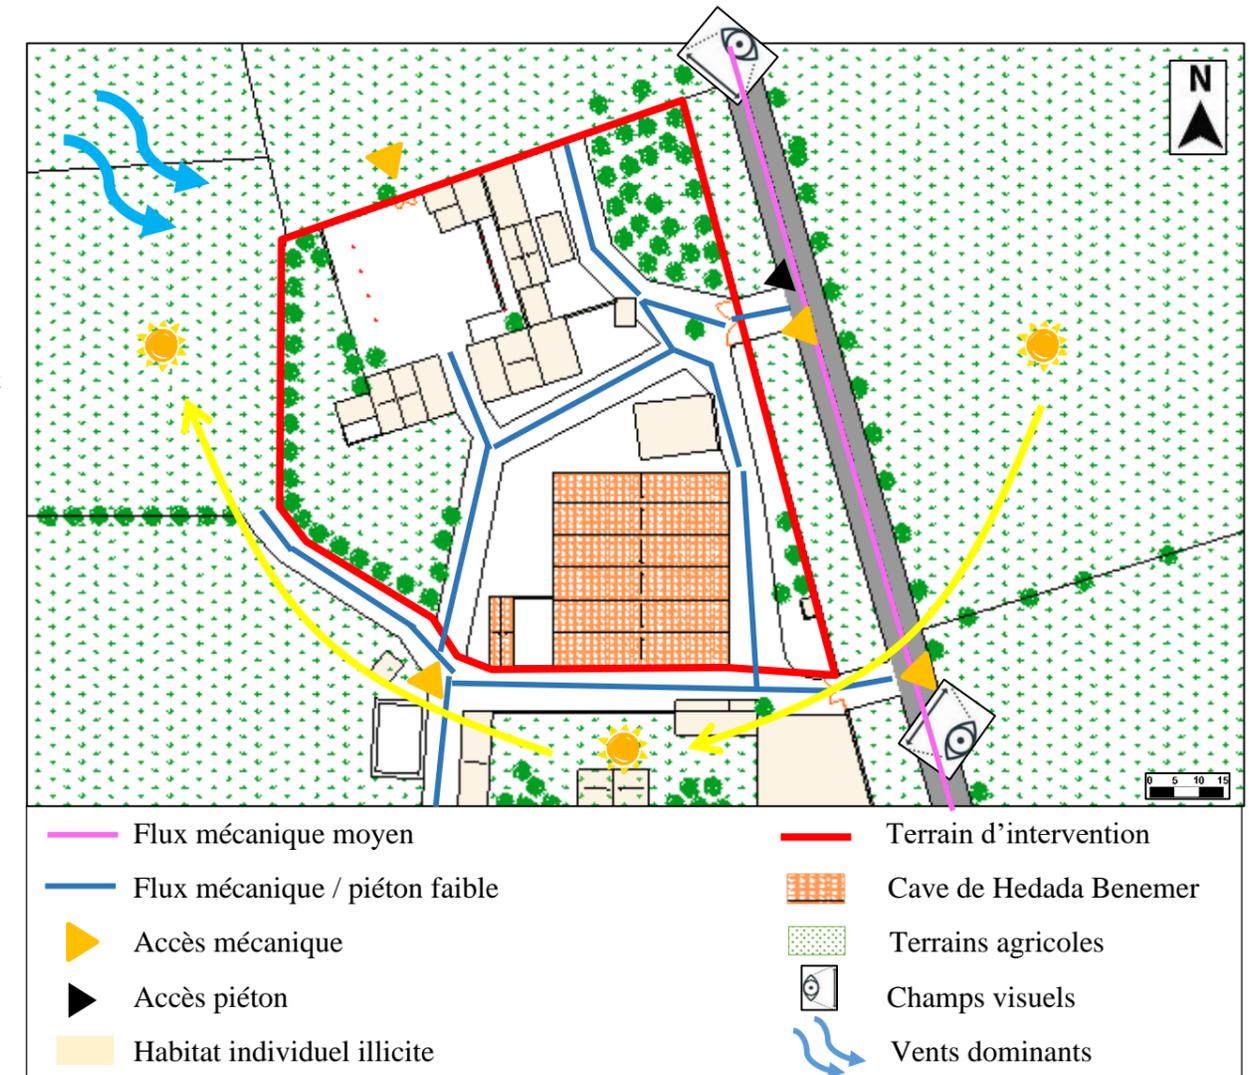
Différents paramètres du site d'intervention ¹⁰⁸
